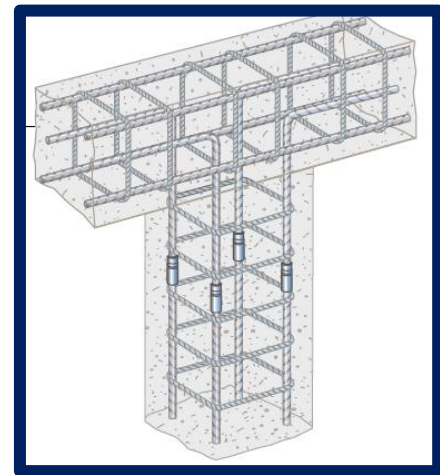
En lugar de una sección con barras de armaduras dobladas.
